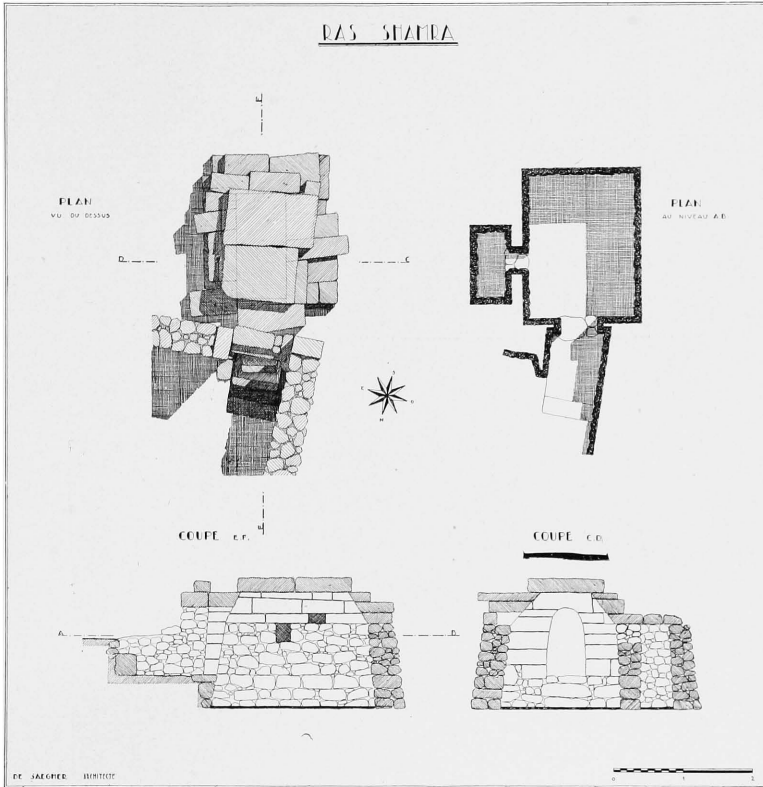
Plan et coupes du caveau XIII (p. 76).
